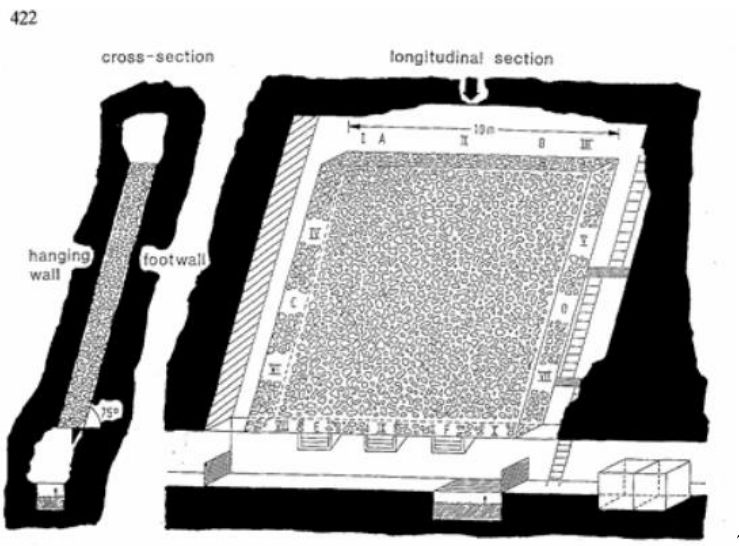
Vista transversal y longitudinal de caserón en Mina Ilba
